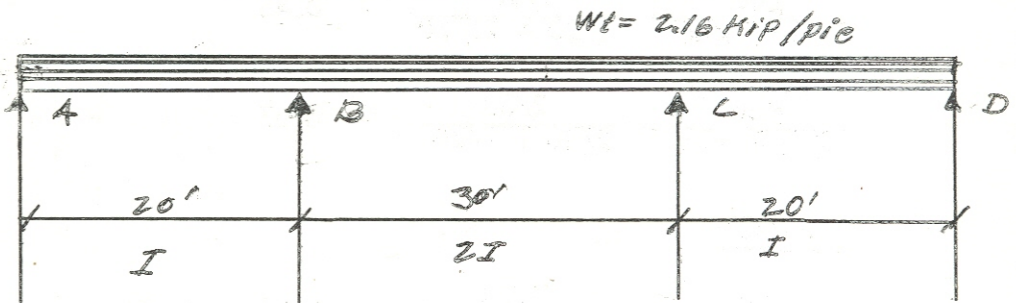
Viga Continua, de Tres Tramos de Sección Variable.
